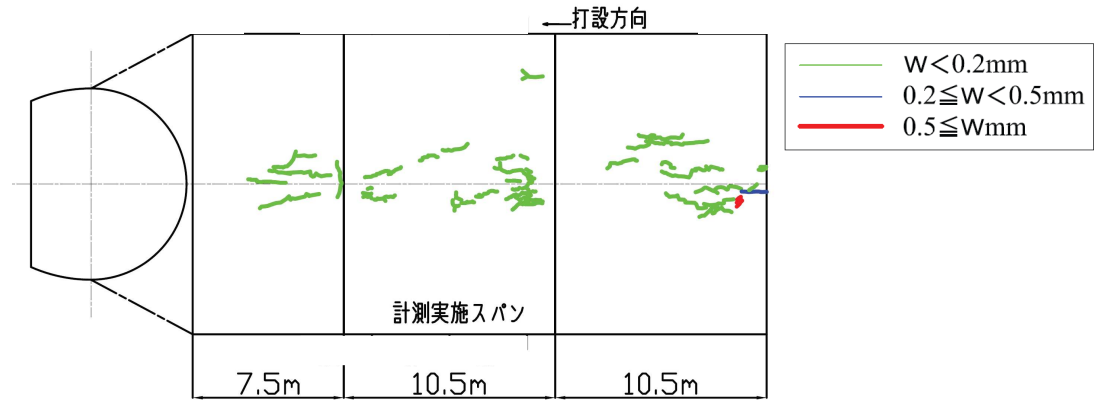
ひび割れの計測箇所（夏期施工）
